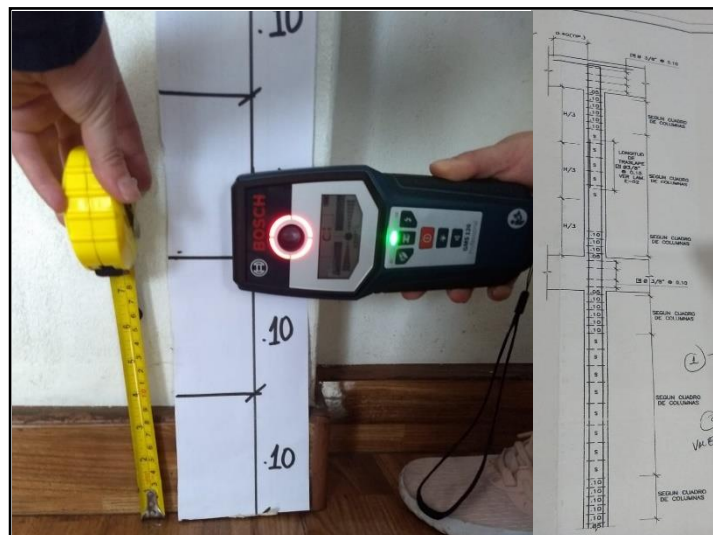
Ubicación de acero de estribos en columna, detectado a cada .10m. como especifica en el cuadro de columnas.
